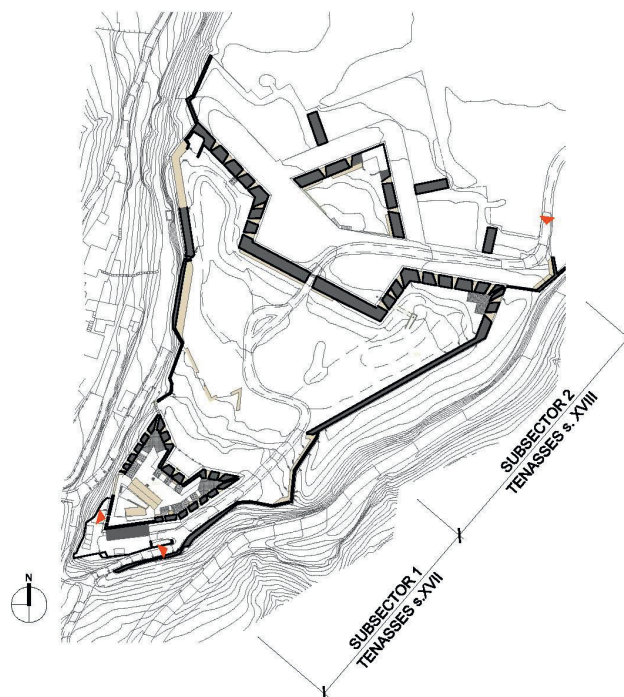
Planta de fortificació de Tenasses. Planimetria propietat de la Generalitat de Catalunya.
